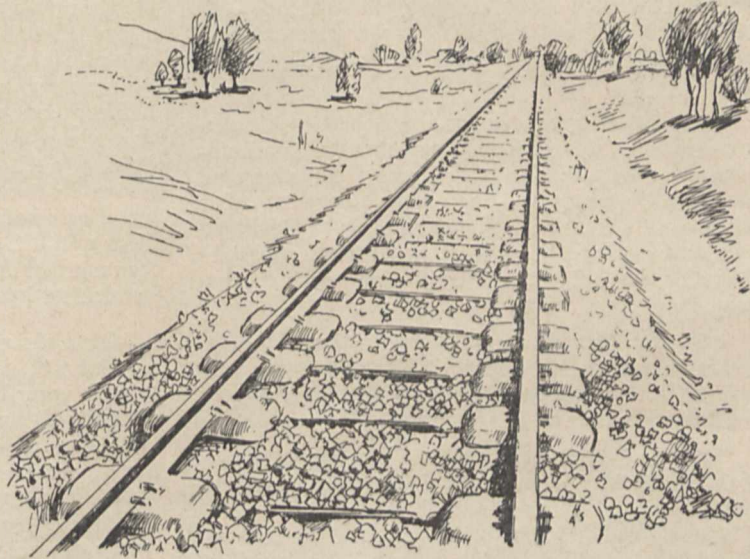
Bahnstrecke mit Schwellen aus Beton.
